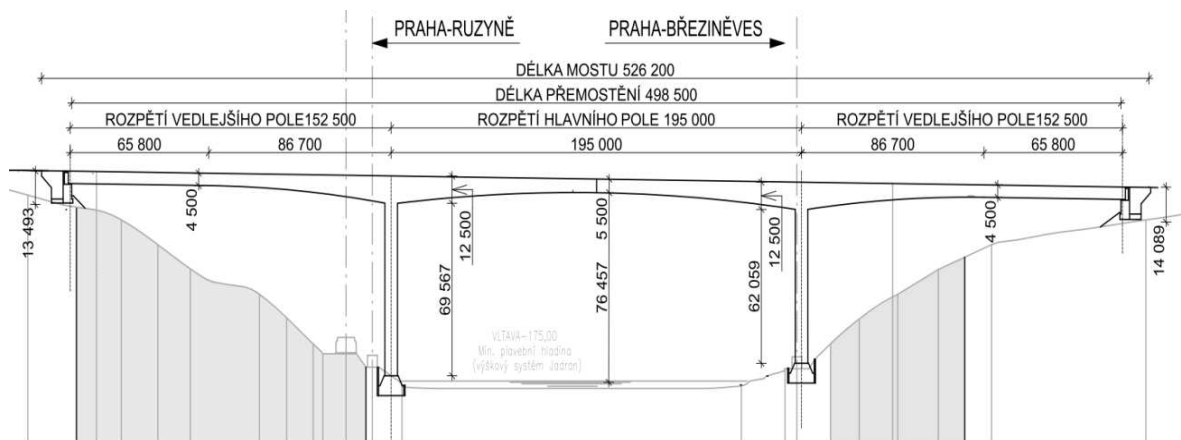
Podélný řez letmé betonáže se svislými podpěrami – varianta 1
